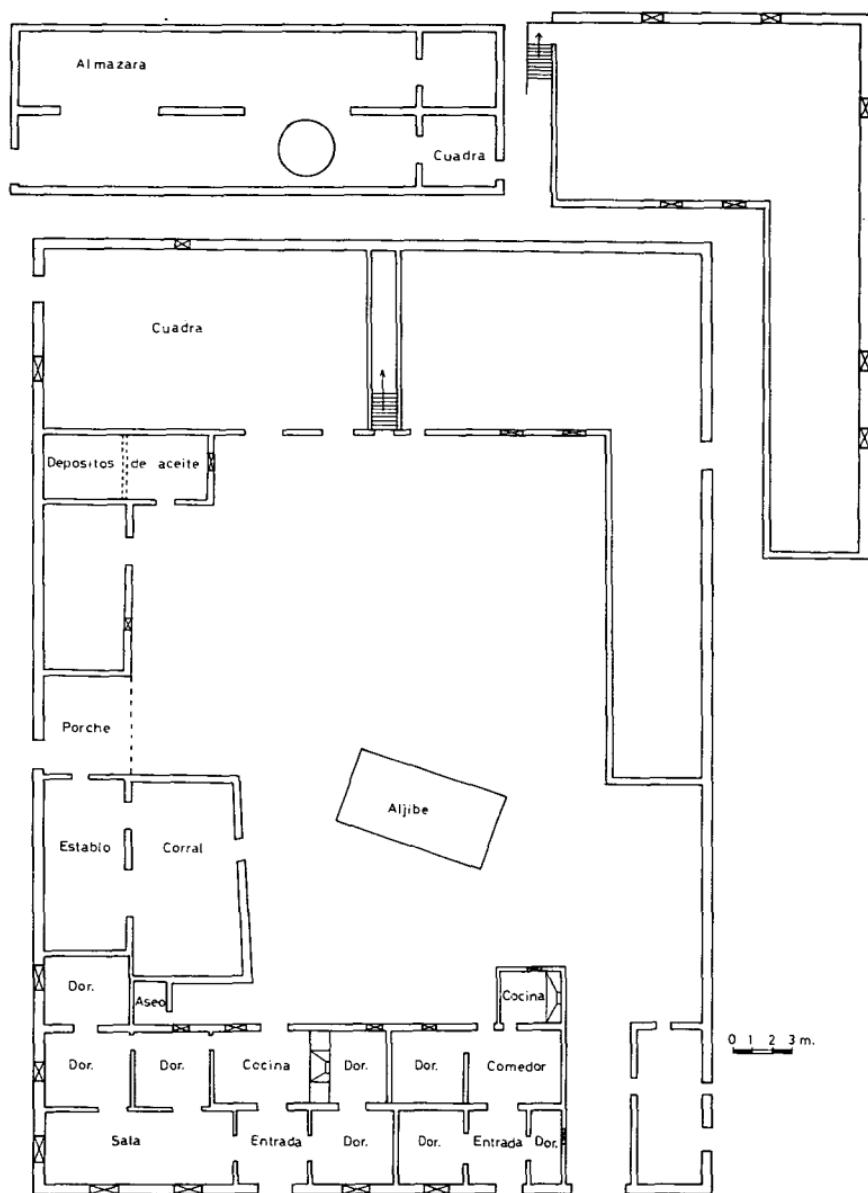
Detalle de la distribución de la vivienda construida en la finca «De Quiles».
